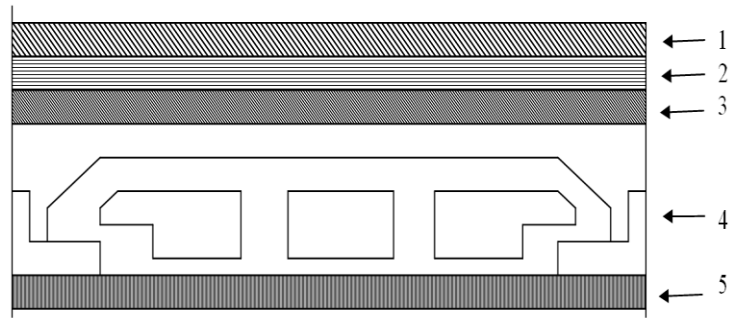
Schéma statique de plancher étage courant en dalle à corps creux
